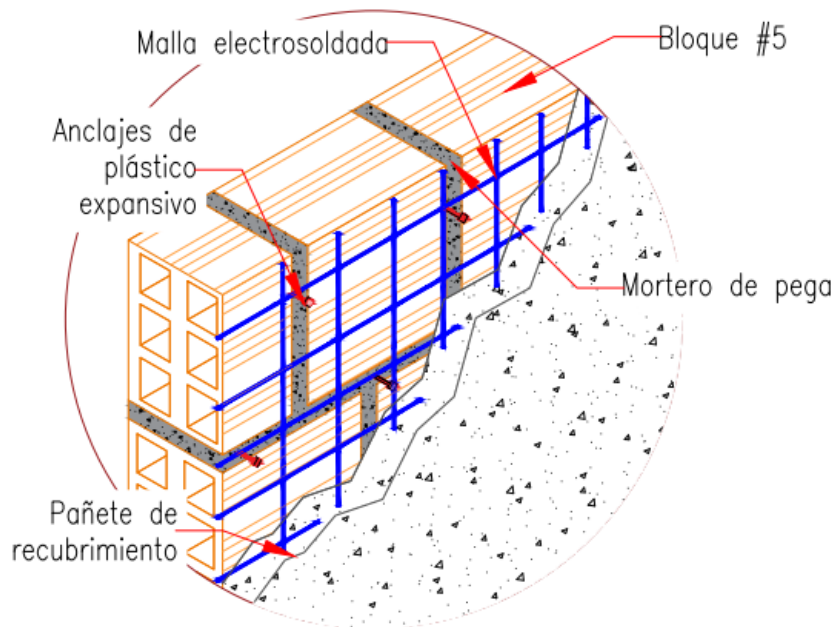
Detalle refuerzo de muro. Fuente (Elaboración propia).
